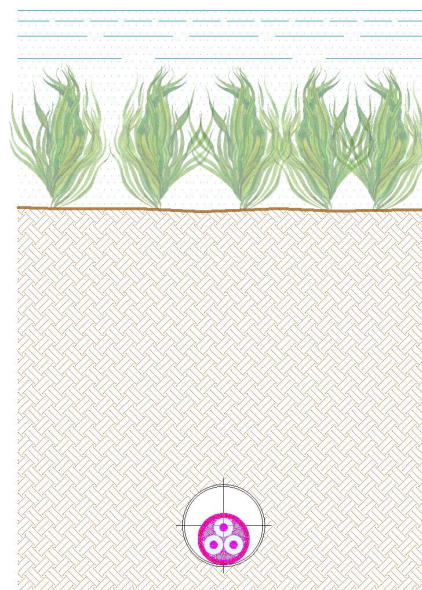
Protezione del cavidotto all'interno di un contro-tubo installato nel fondale marino mediante TOC.
